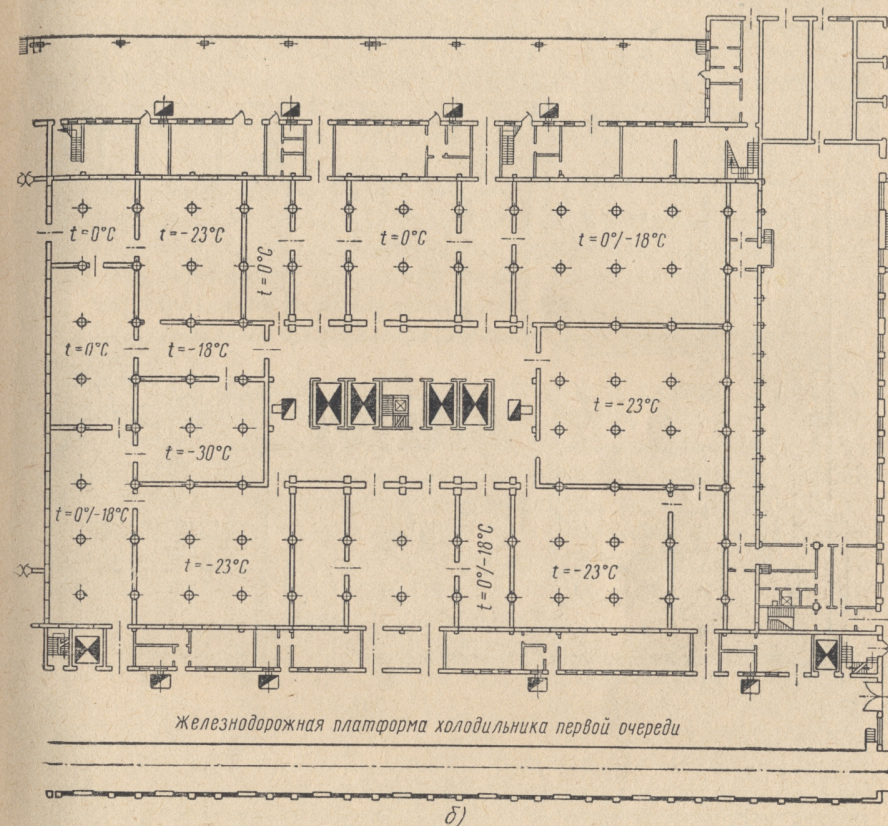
б. Планировка первого этажа первой очереди строительства холодильника № 12 в Москве
